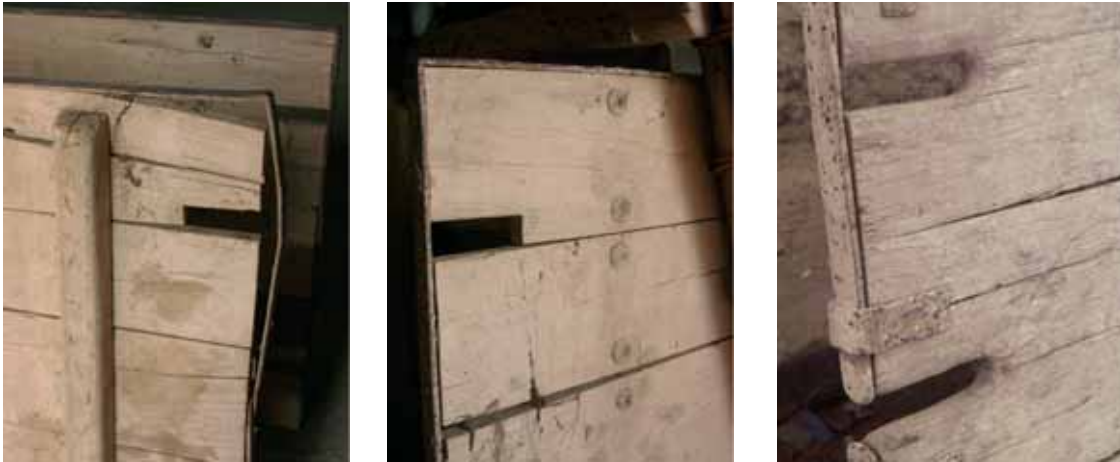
a 13 Detalles de refuerzo en el borde, clavos de sujeción del barzón y rebajes de las manetas.
